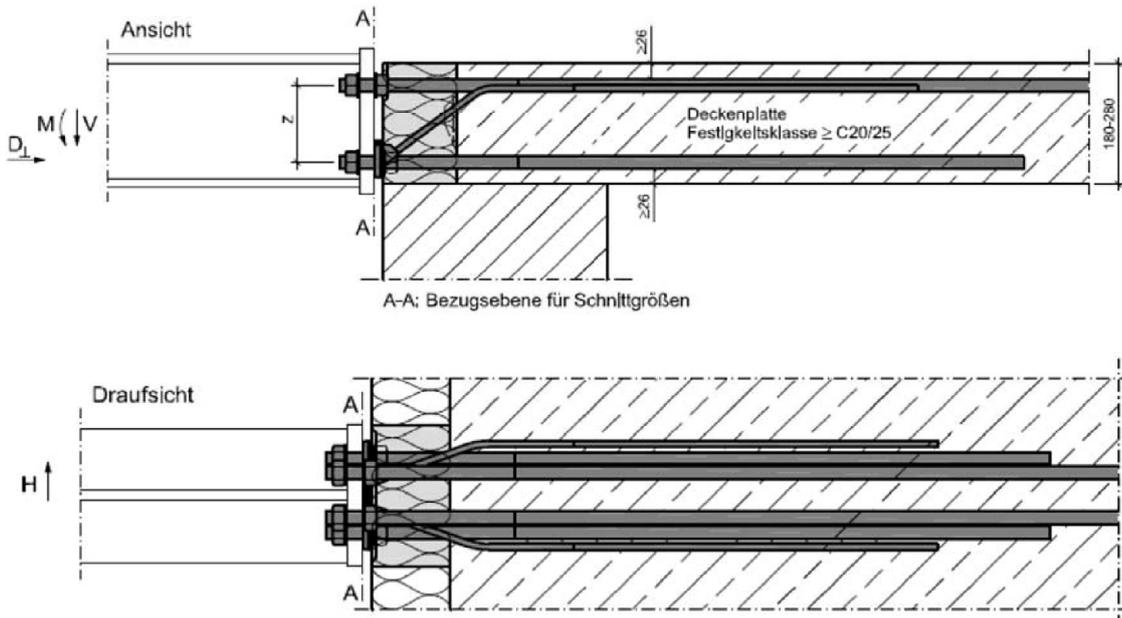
und 72: Schöck Isokorb® XT Typ SK-MM2-VV1, Schnittgrößendefinition
